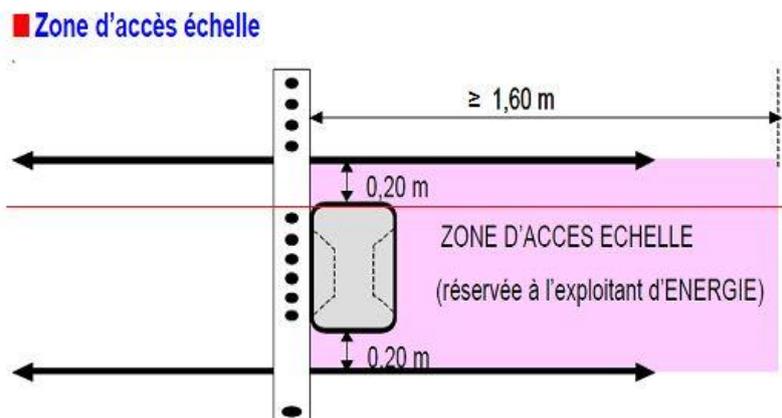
Zone d'accès échelle sur Réseau BT et mixte
